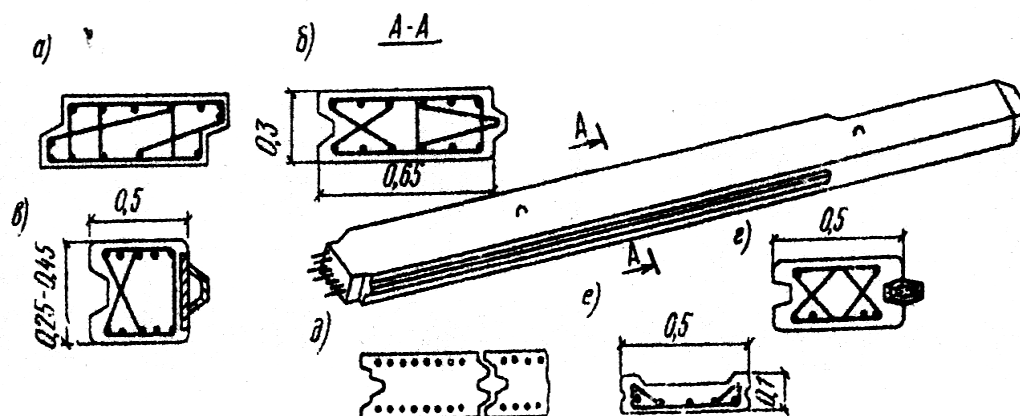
Плоские железобетонные шпунты с различными типами сопряжений:
